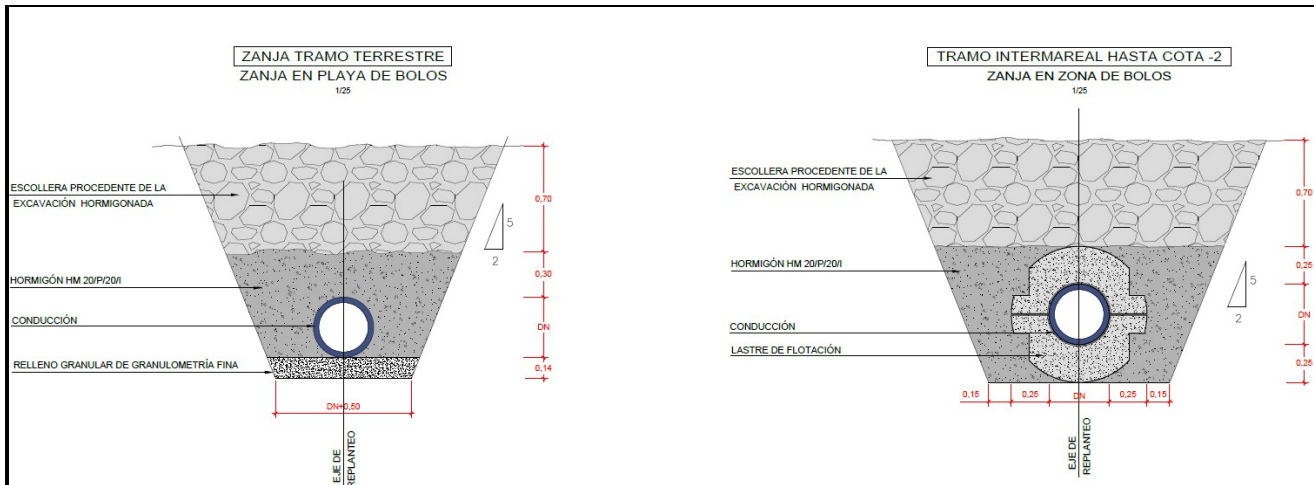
Secciones tipo en Tramo Terrestre y Tramo Intermareal hasta cota -2 m
